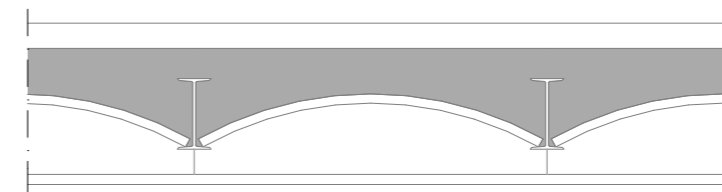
Detalle de forjado de vigueta metálica con entrevigado de revoltón de ladrillo macizo y relleno de hormigón
